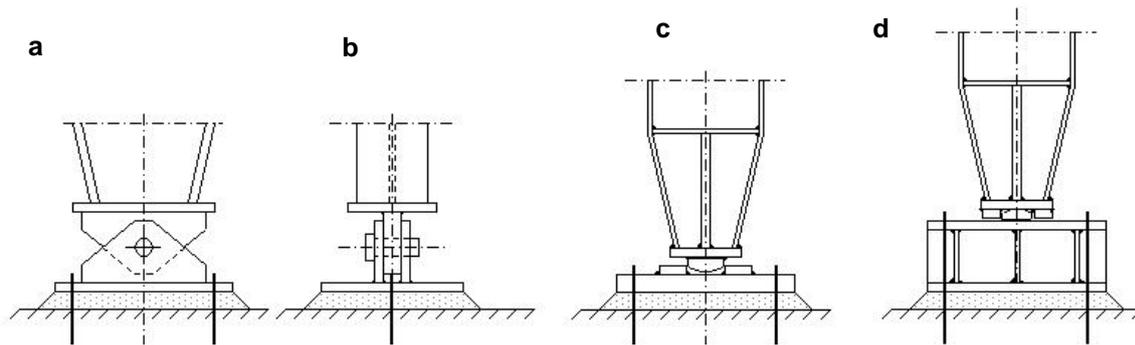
Ausführungsbeispiele für in der Rahmenebene gelenkige Stützenfußkonstruktionen
